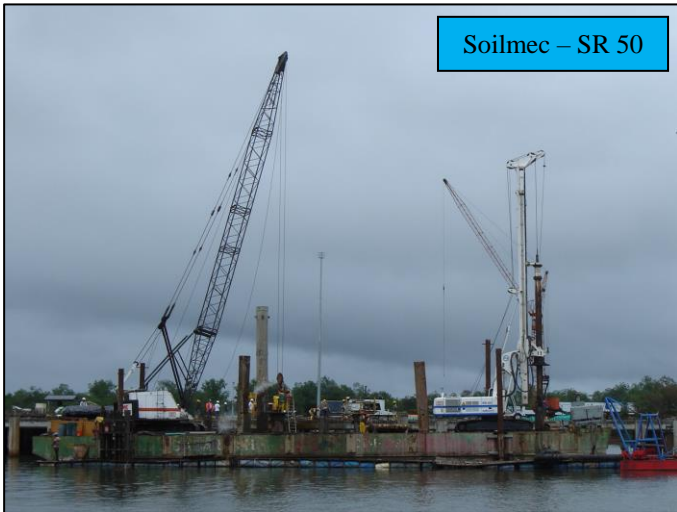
a 68 Proceso constructivo de un pilote in-situ de extracción de sección circular con camisa perdida
